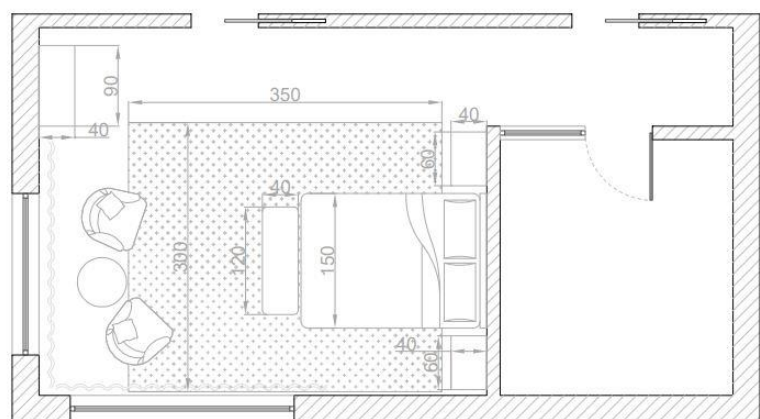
Planta de Equipamento Cotada da Suite Raquel L.
